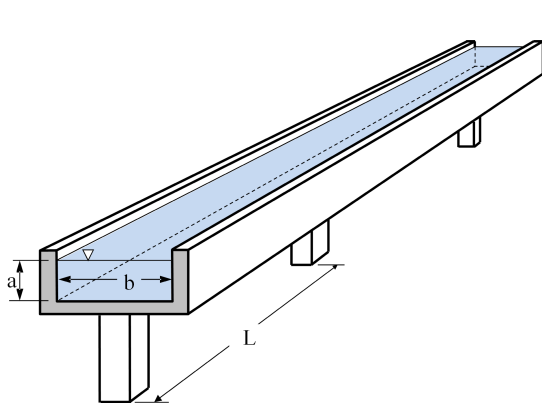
Tramo de canal navegable sobre pilares. Puente de Magdeburgo, Alemania.
